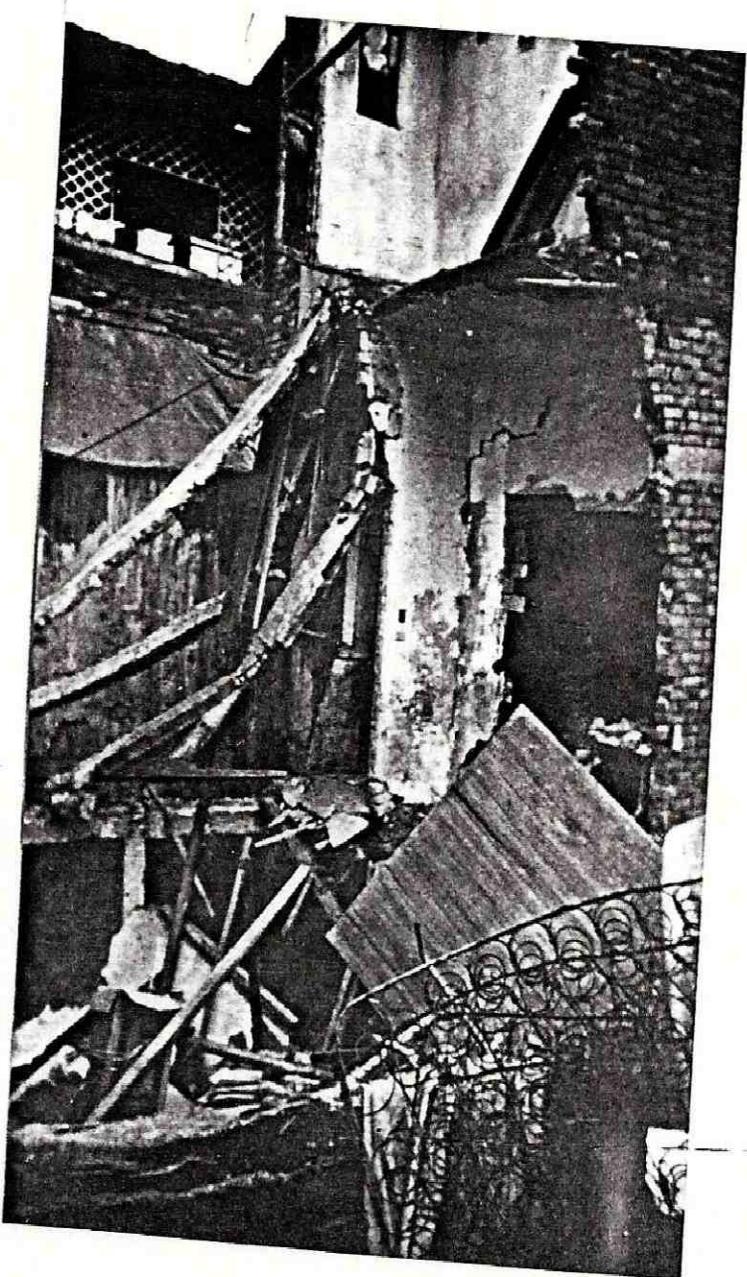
fachada de la casa, la cual presenta grietas e inclinación.
